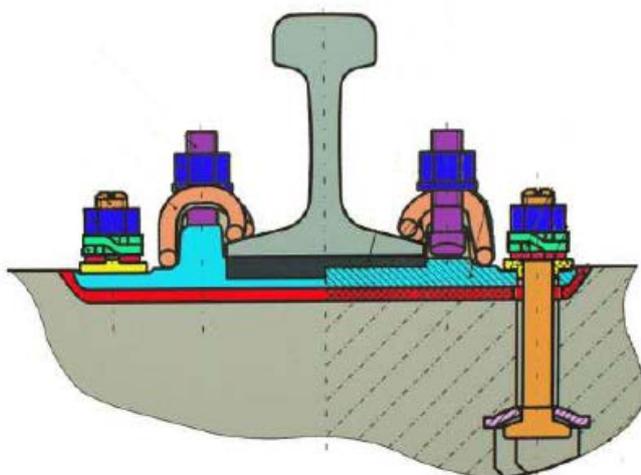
Упругое раздельное рельсовое крепление с прутковыми торсионными клеммами для железобетонных шпал, рельсовые подкладки крепятся анкерными болтами к шпале, клеммы затягиваются с помощью клеммных болтов, установленных на подкладке
